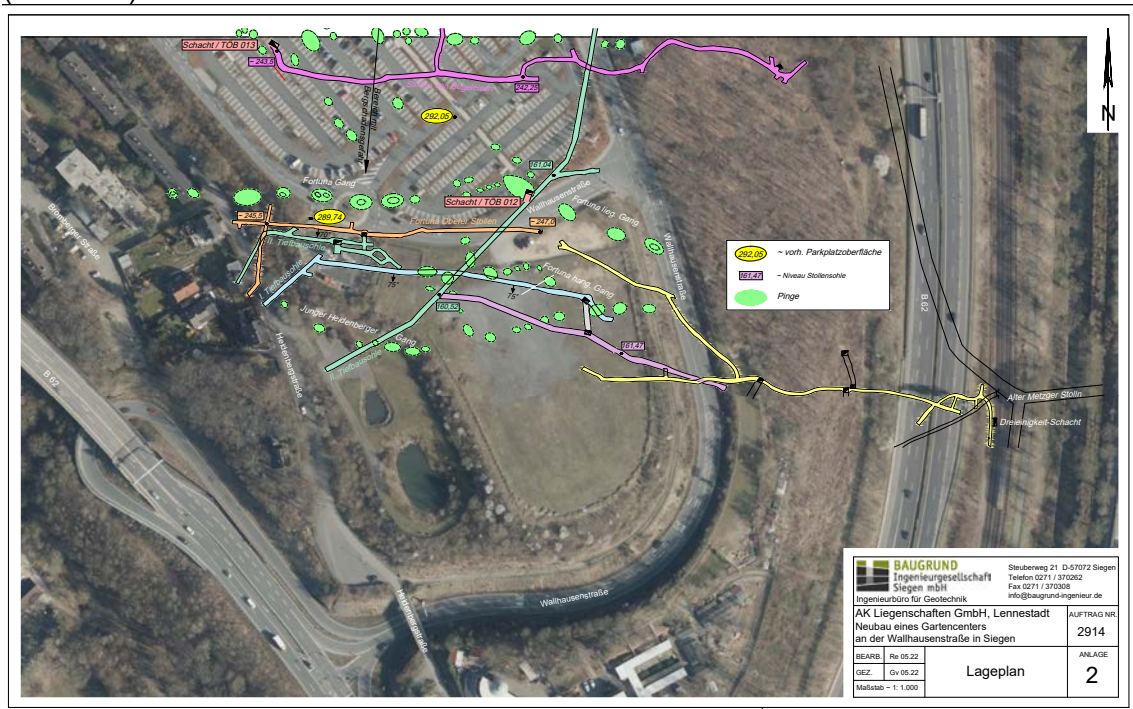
Untertägiger und oberflächennaher Bergbau im Plangebiet
